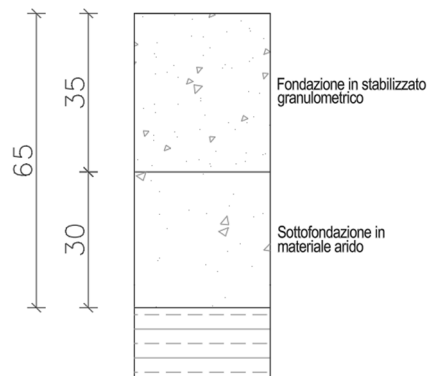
Particolare del pacchetto stradale non asfaltato
